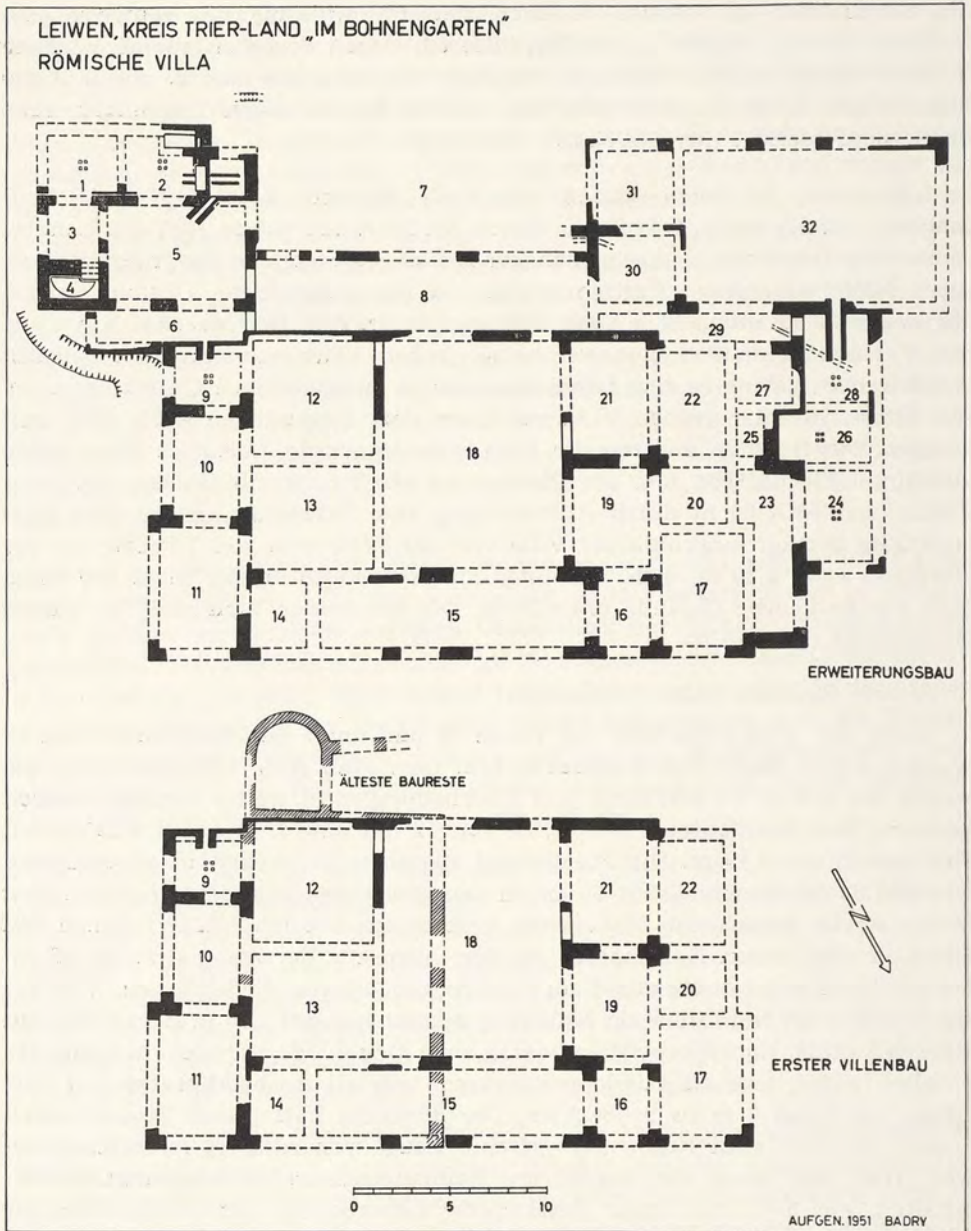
Villa von Leiwien und ihre verschiedenen Umbauten; Grundrisse
